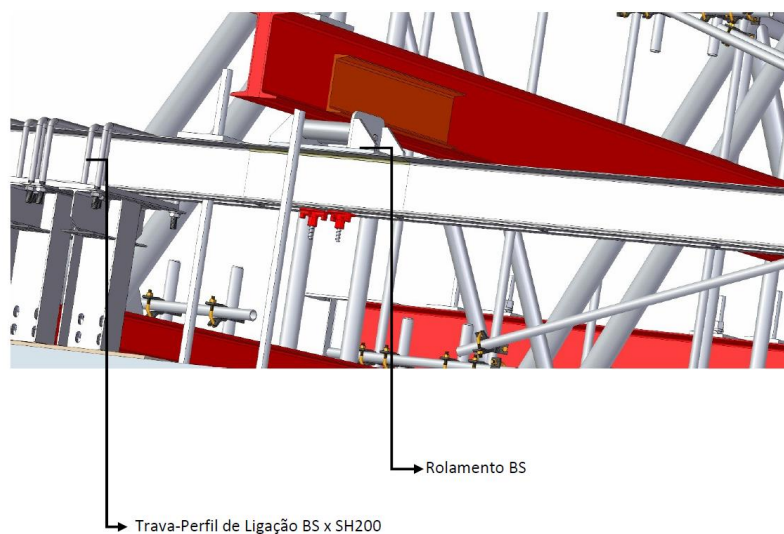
Setas indicando Rolamento e Trava-Perfil de Ligação
